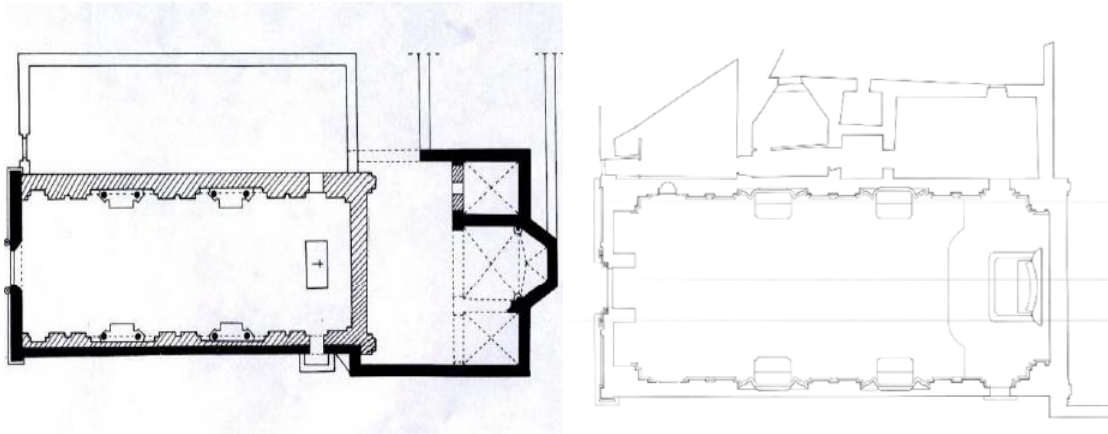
Pianta della chiesa dei Santi Nicandro e Marciano
